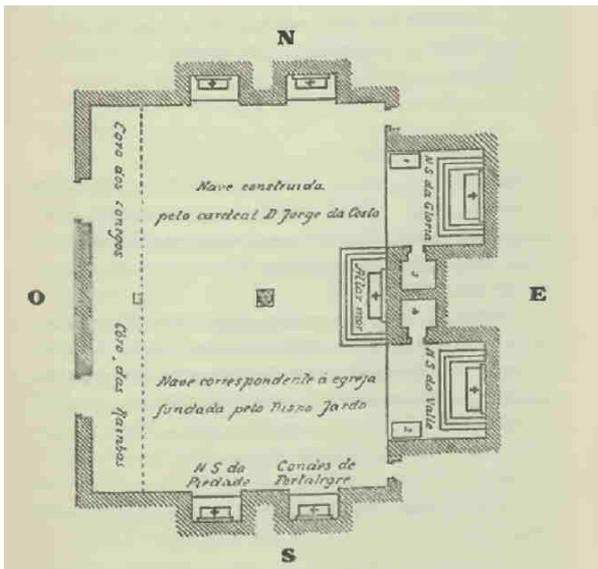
Planta da igreja após as obras de 1474, segundo reconstrução feita por Henrique Loureiro.
